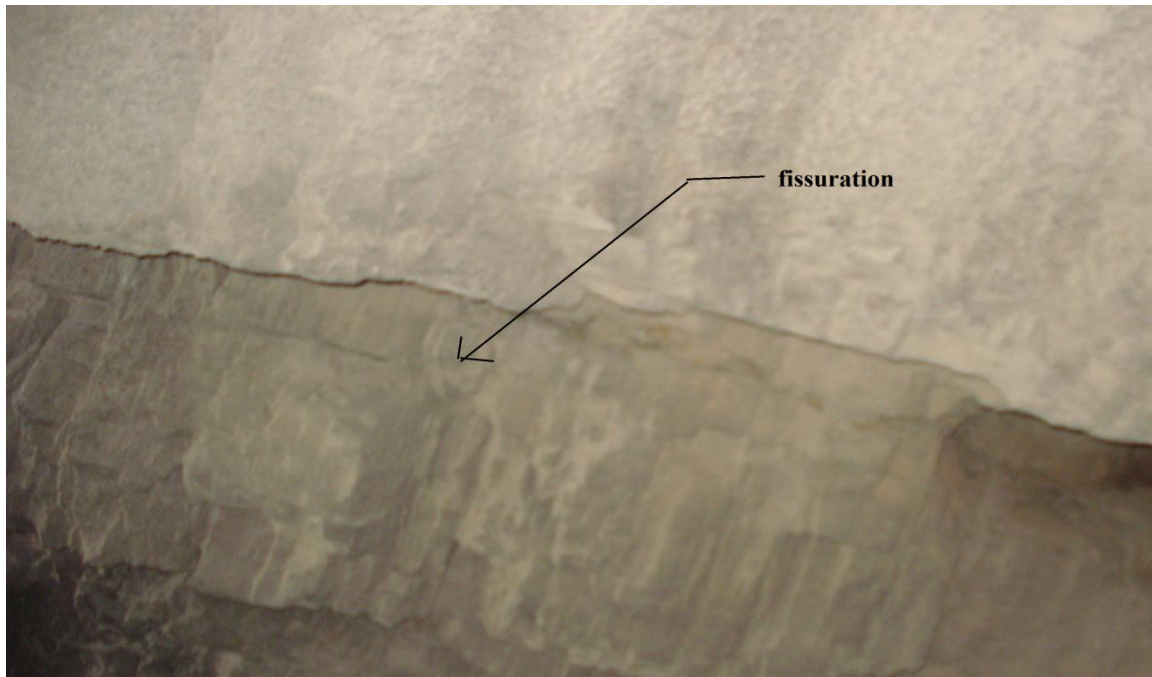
fissuration des roches (la mine de CHaabet El-hamra)
